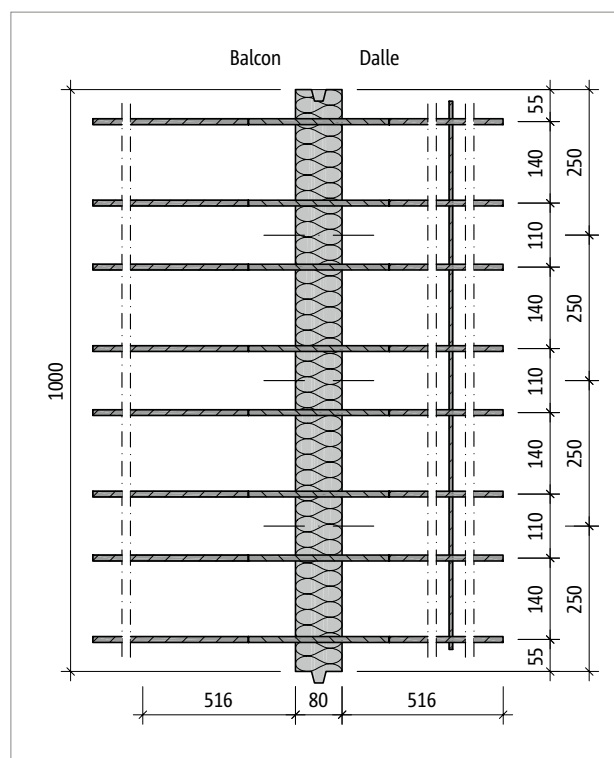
Schöck Isokorb® T type Q-E-VV5 : plan de base du produit
